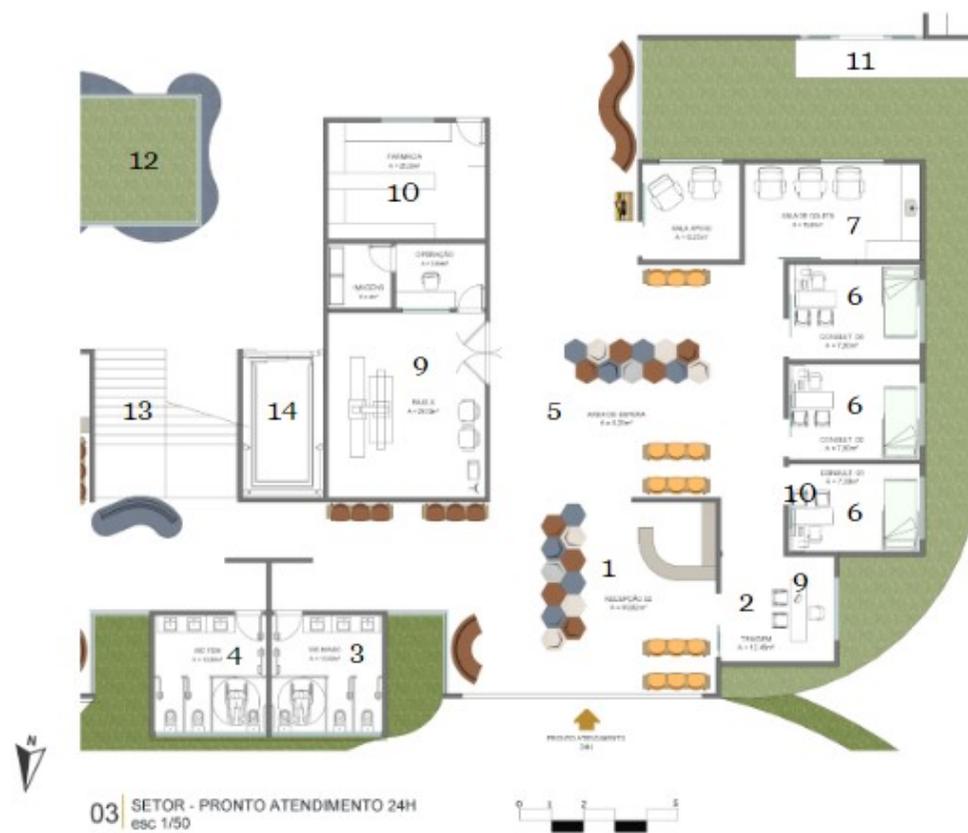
Pavimento térreo – Planta Humanizada – Fonte: Autora, 2023.
